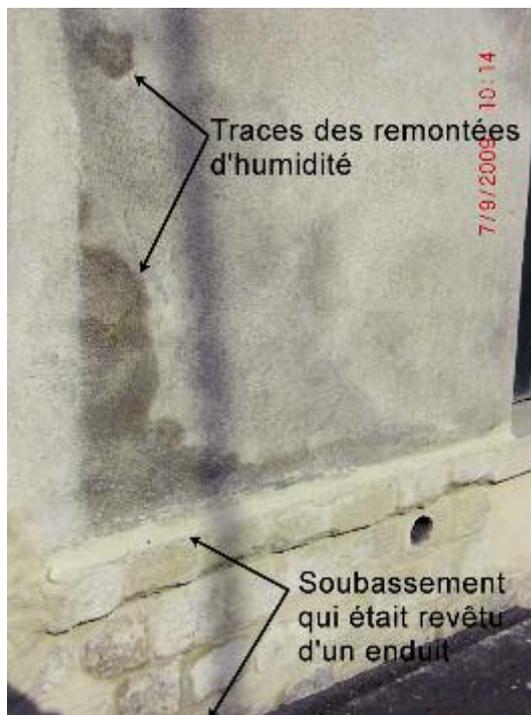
traces des remontées d'humidité (crédit photo D. Poineau)
